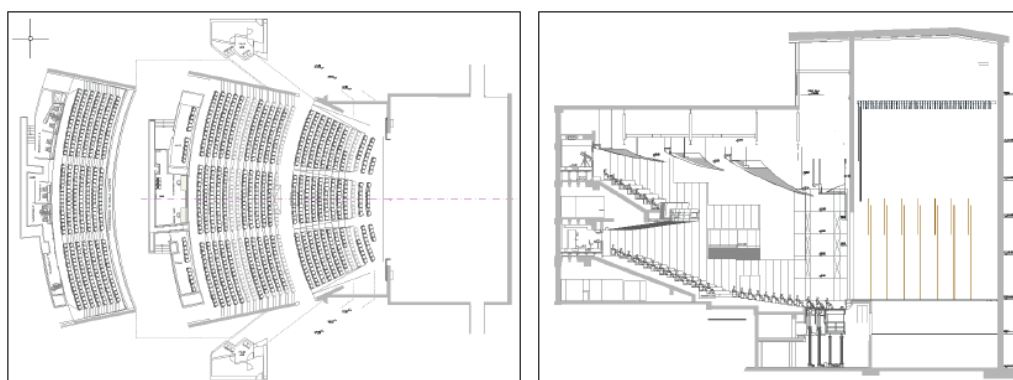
Planos arquitectónicos Auditorio Rafael Frühbeck
